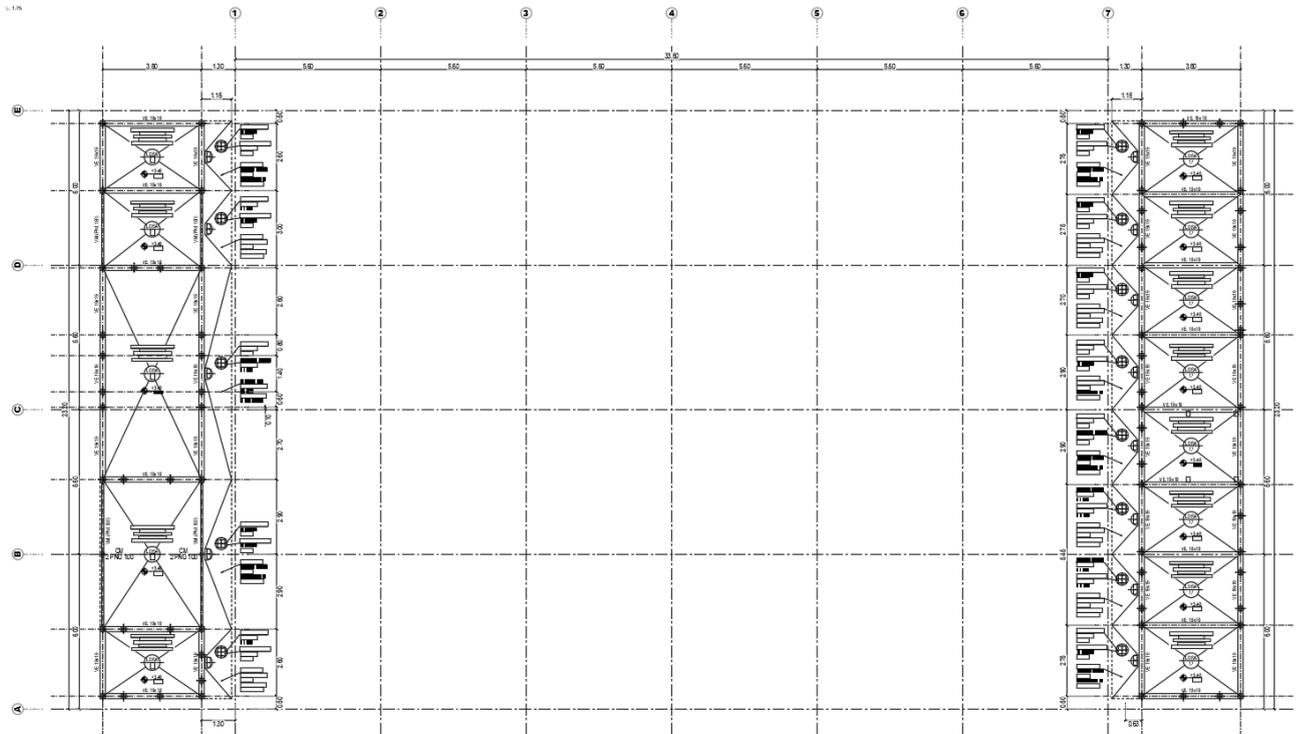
ESTRUCTURA DE SERVICIO TECHO | PLANTA
